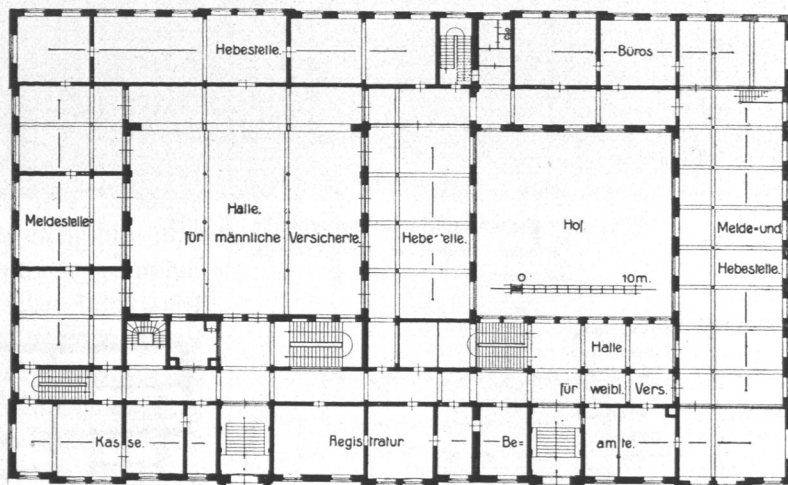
Gebäude für das Versicherungswesen, Grundriß, Erdgeschoß.
